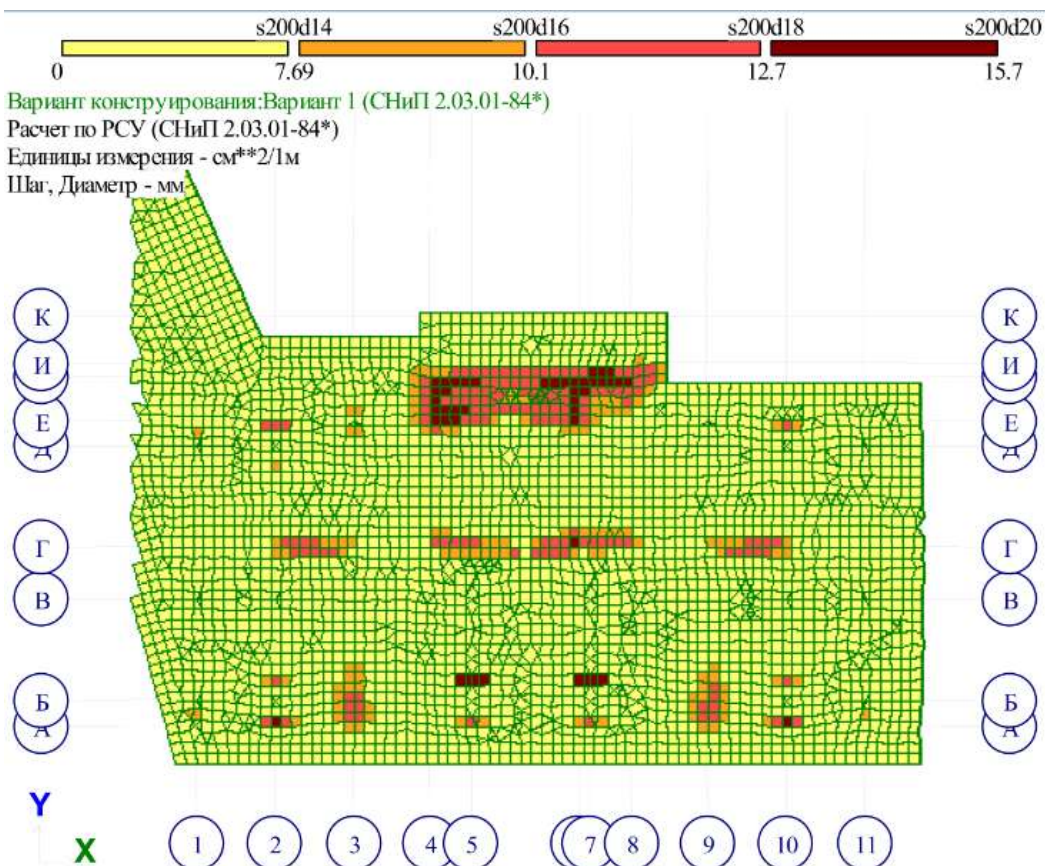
Площадь арматуры на 1 п.м. по оси Y у верхней грани
